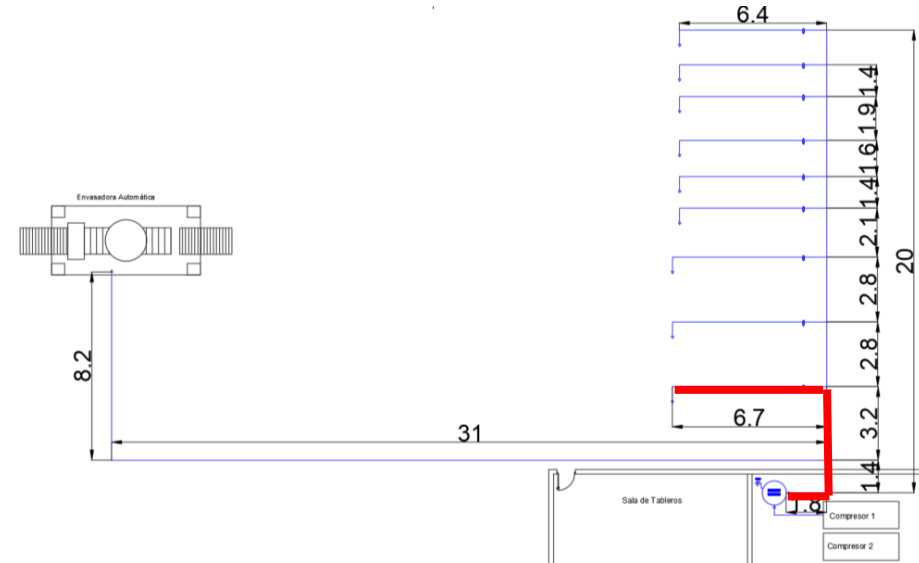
Layout verificación 3 de cañería de aire comprimido
